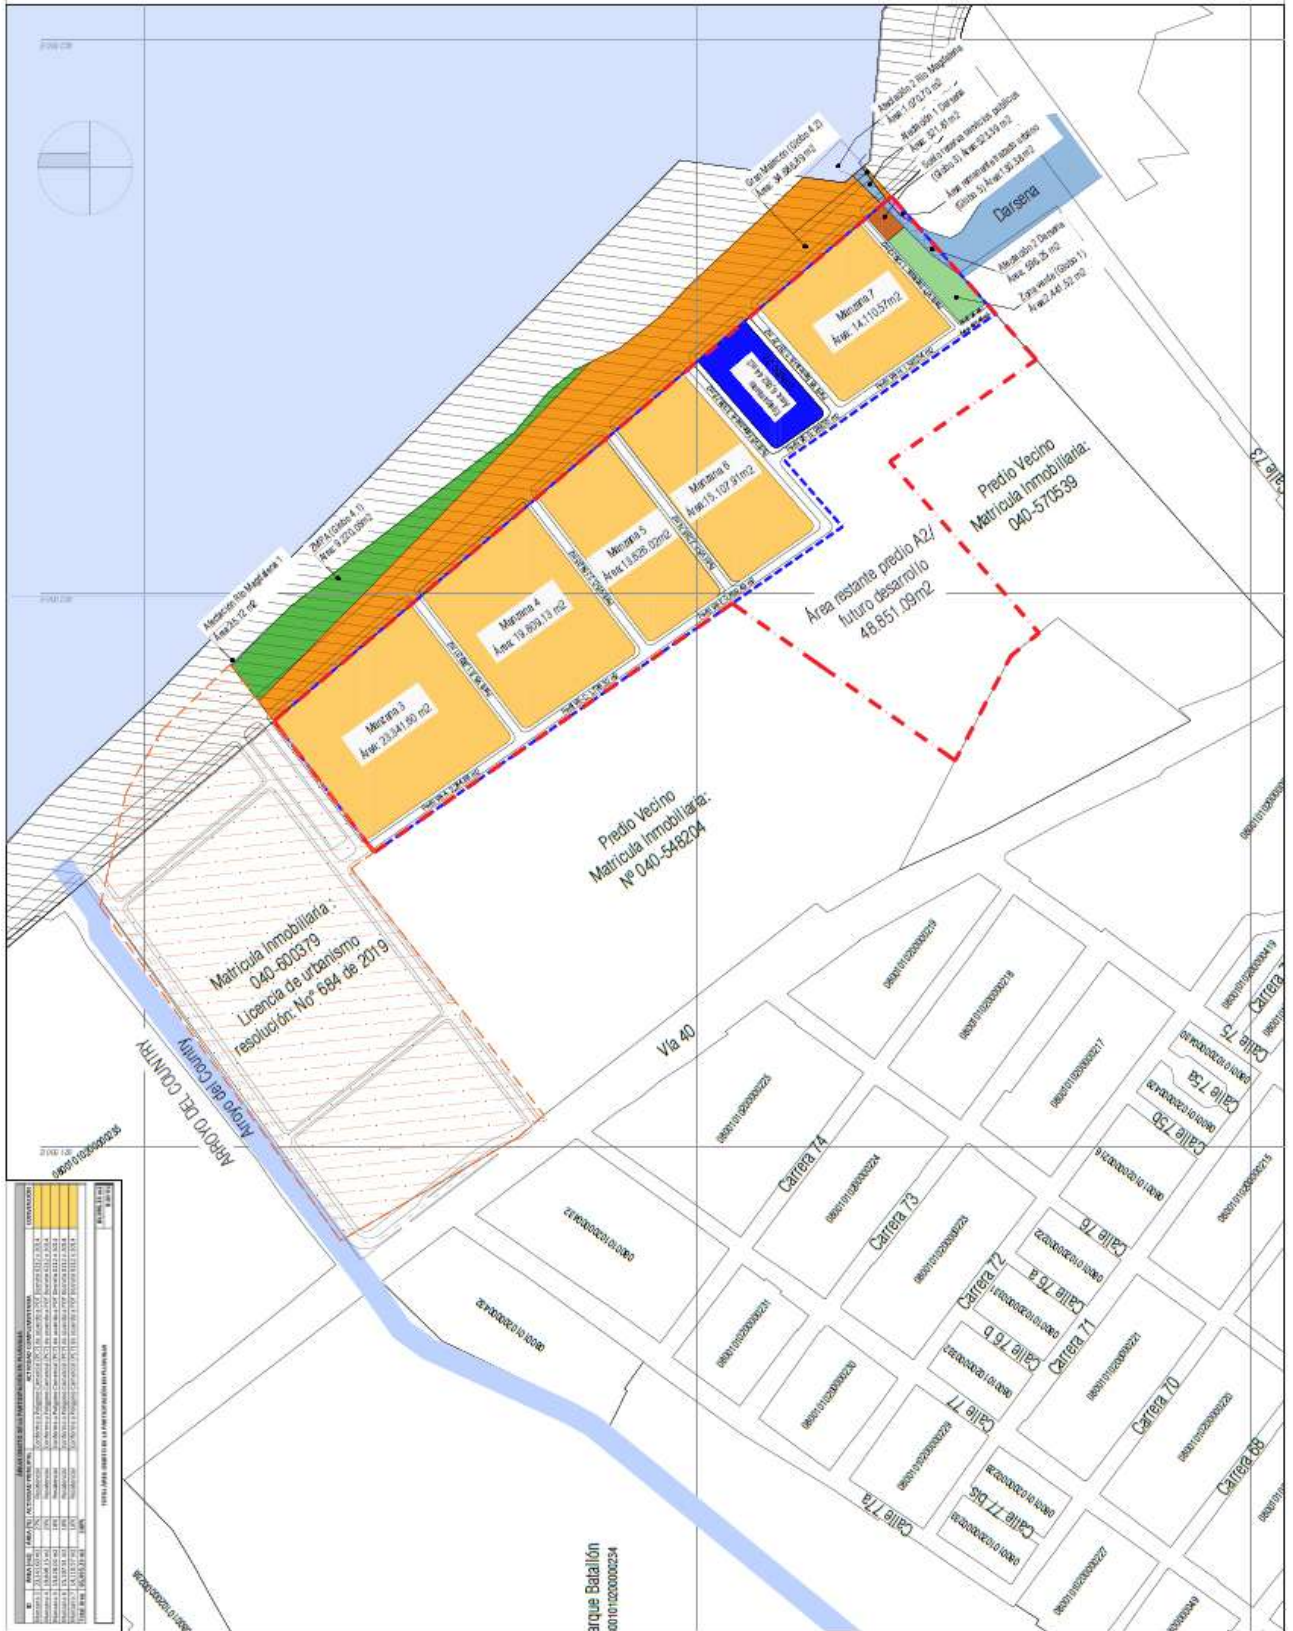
plano de zonas beneficiarias. Ver plano anexo F-009.
